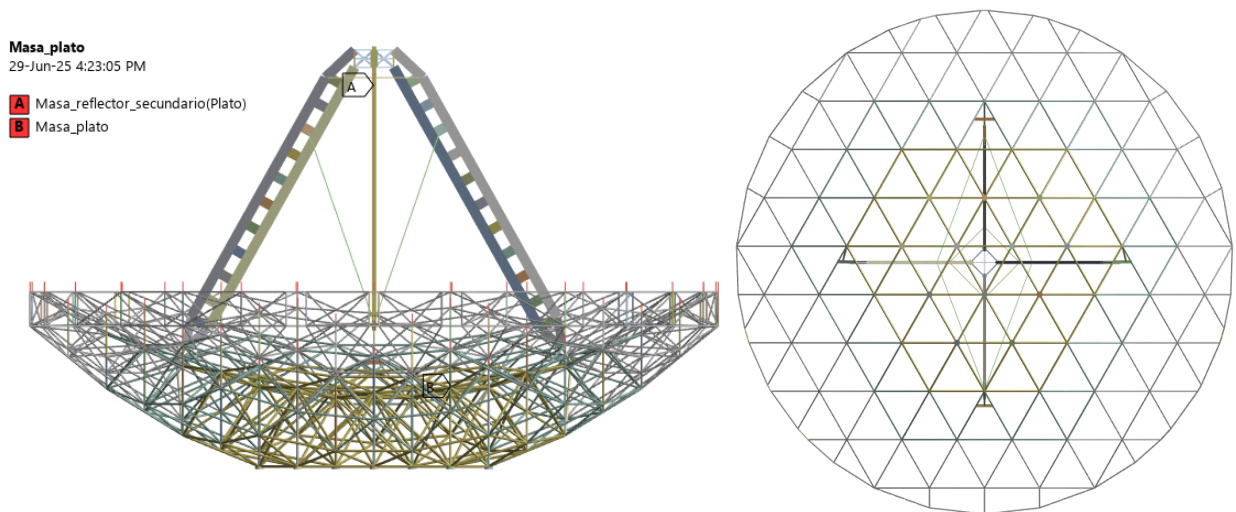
Geometrías de las antenas y el entramado de vigas simplificada.
